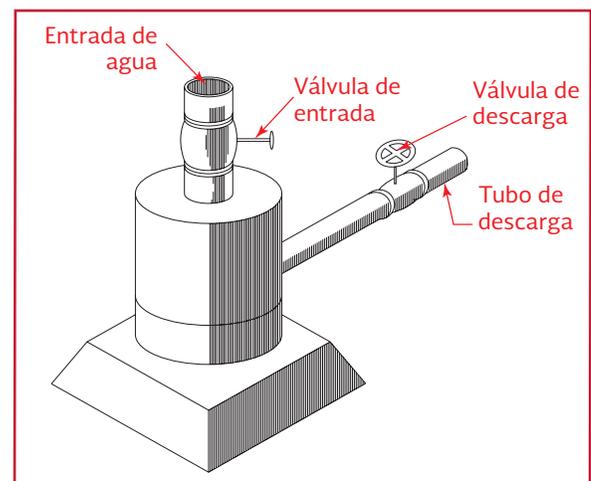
Lavado de pozo con chorro vertical y pozo cerrado
